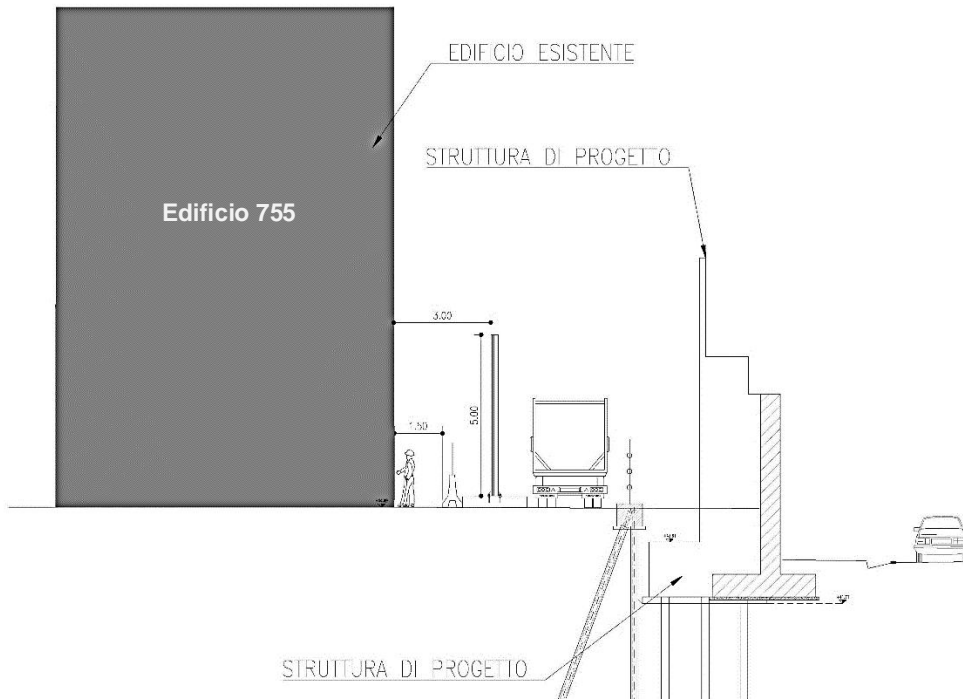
Sezione rappresentativa dell'attività di Fase 3 – getti fondazione
